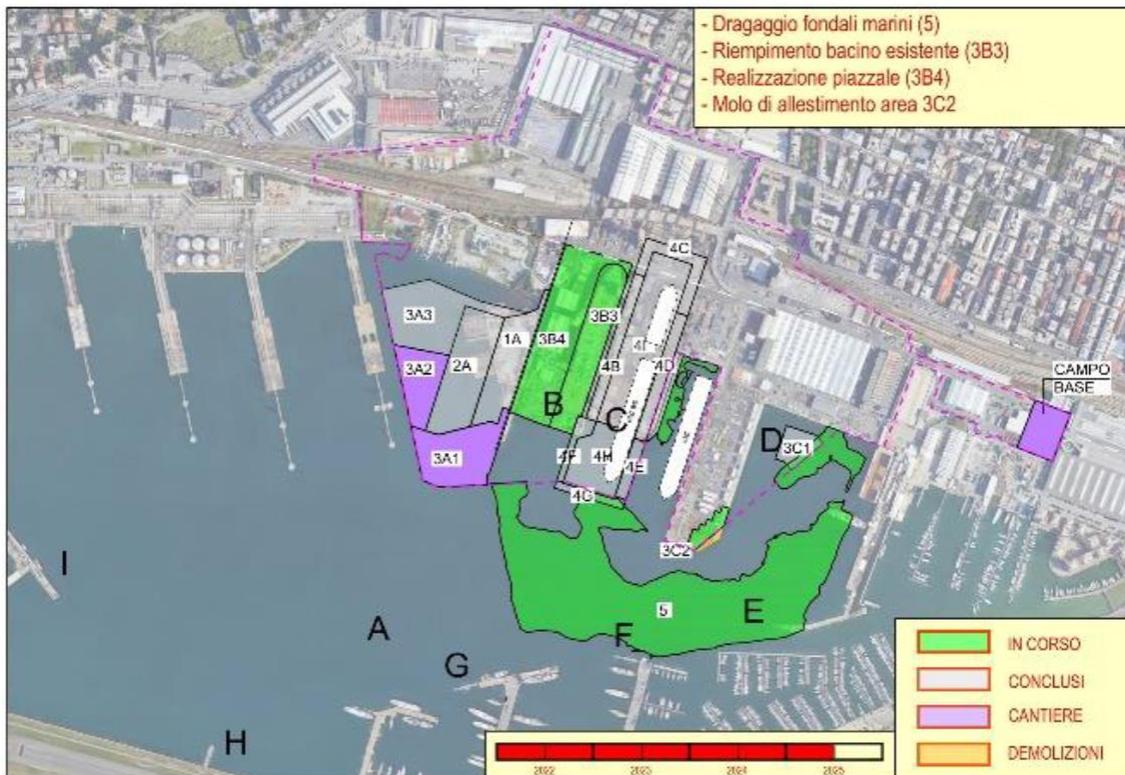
Planimetrie con le aree di cantiere – Fase 6
